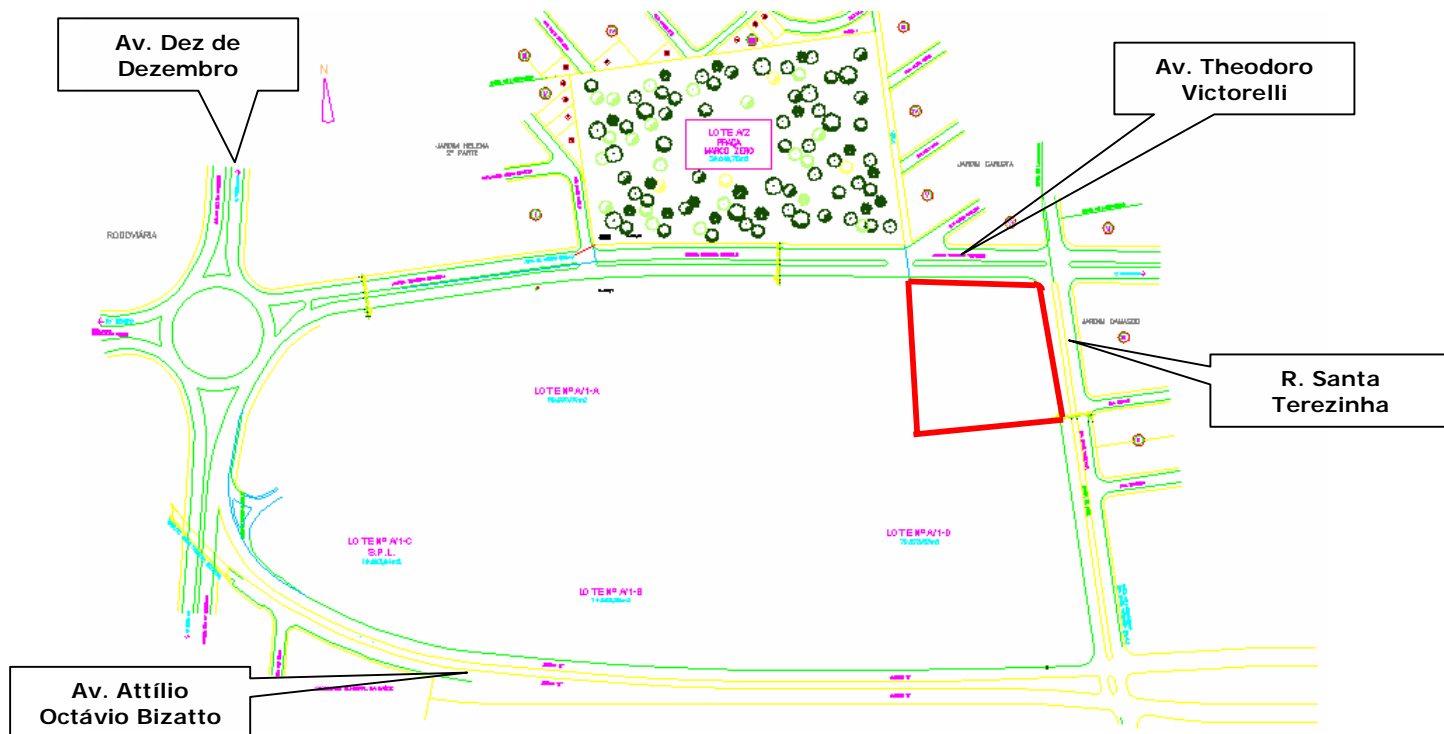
Detalhamento do arruamento próximo à área de intervenção
